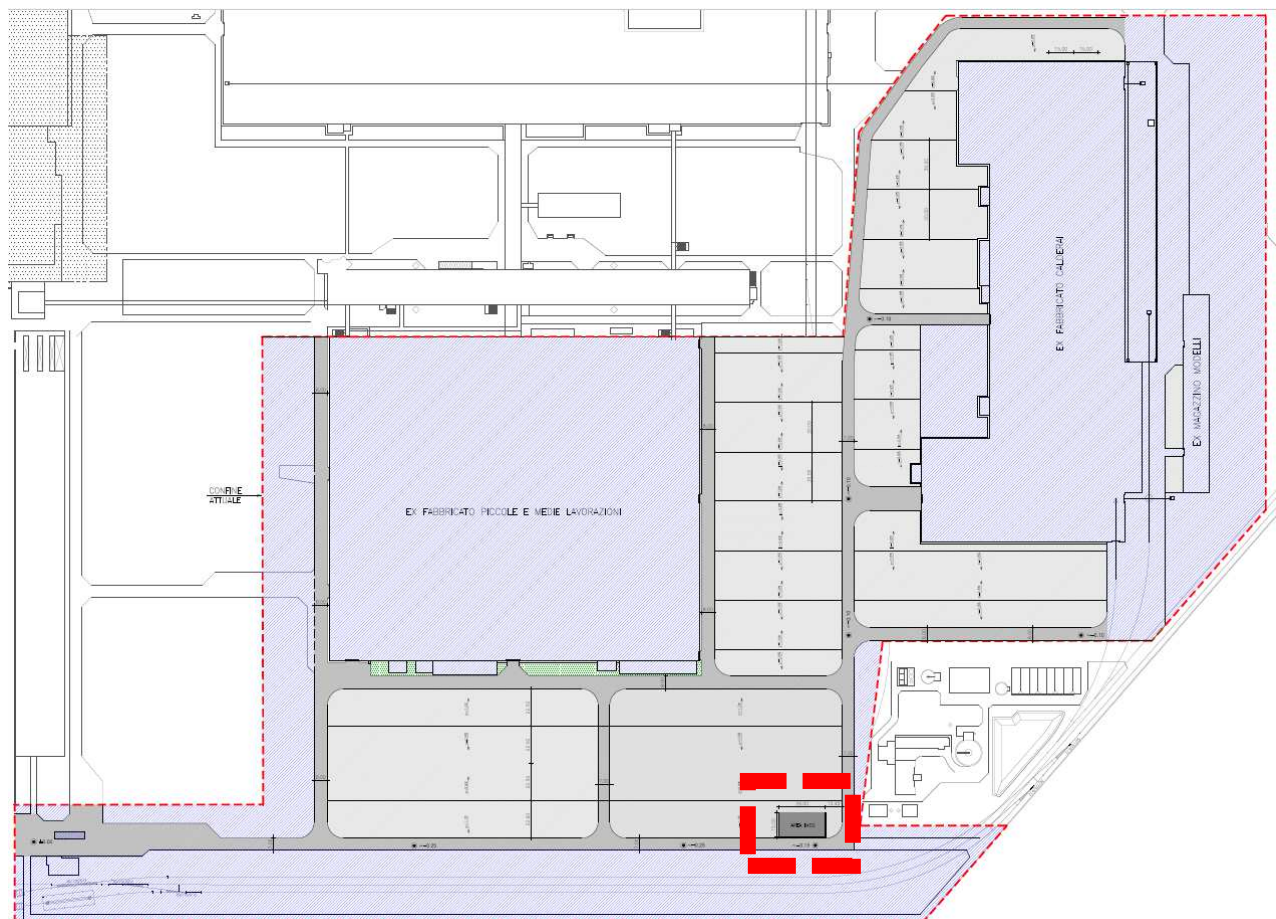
Planimetria dell'area in oggetto dell'intervento con evidenziato in rosso l'area IMDG
